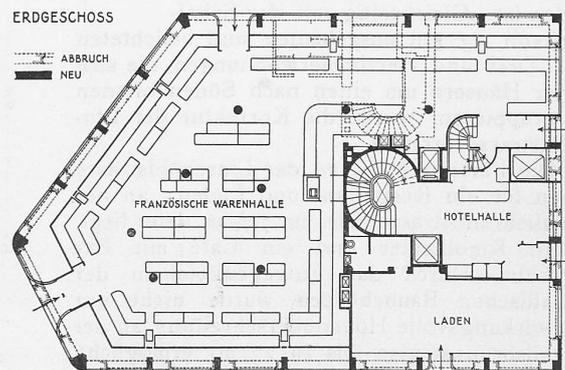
bis 3. Grundrisse des Geschäftshaus-Umbaues zum „Touring-Hotel“ in Zürich. — Masstab 1 : 400.
